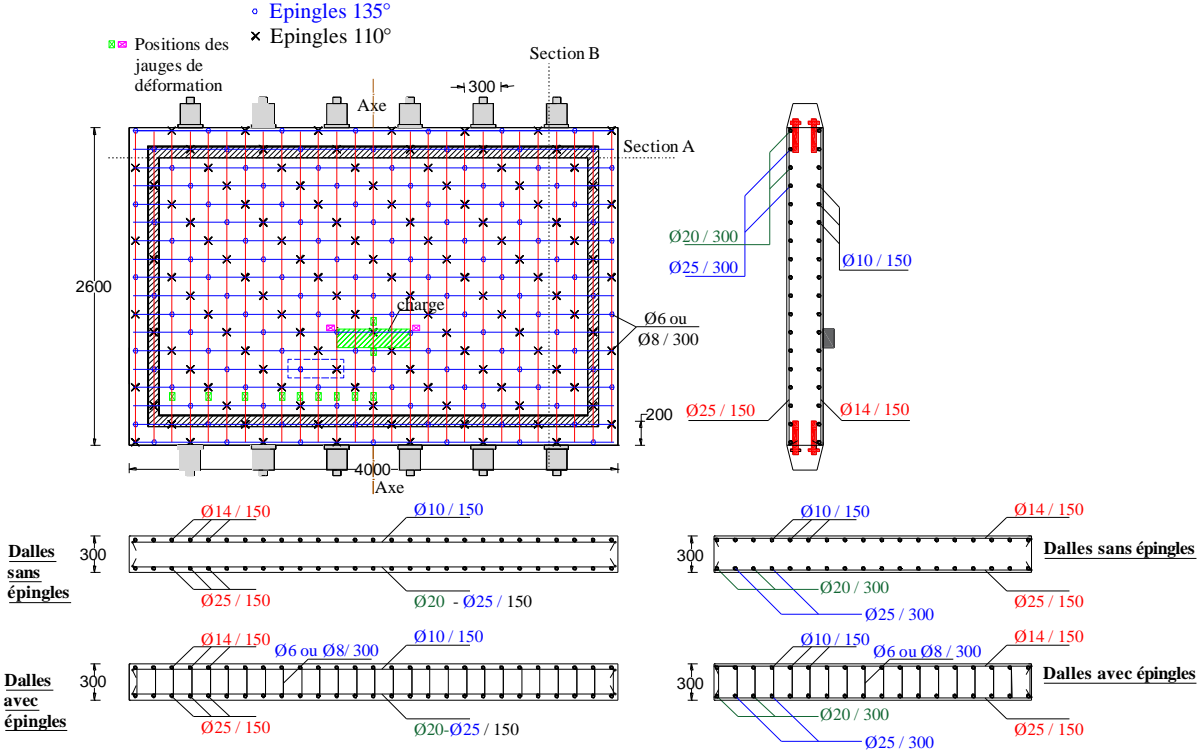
Ferrailage des dalles avec effort axial (compression ou traction), avec et sans épingles
